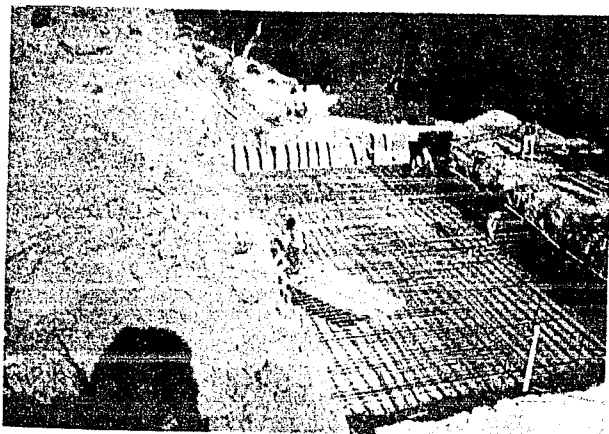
Armado de la zapata del muro de retención en el Km. 11+792 al Km. 11+921.
